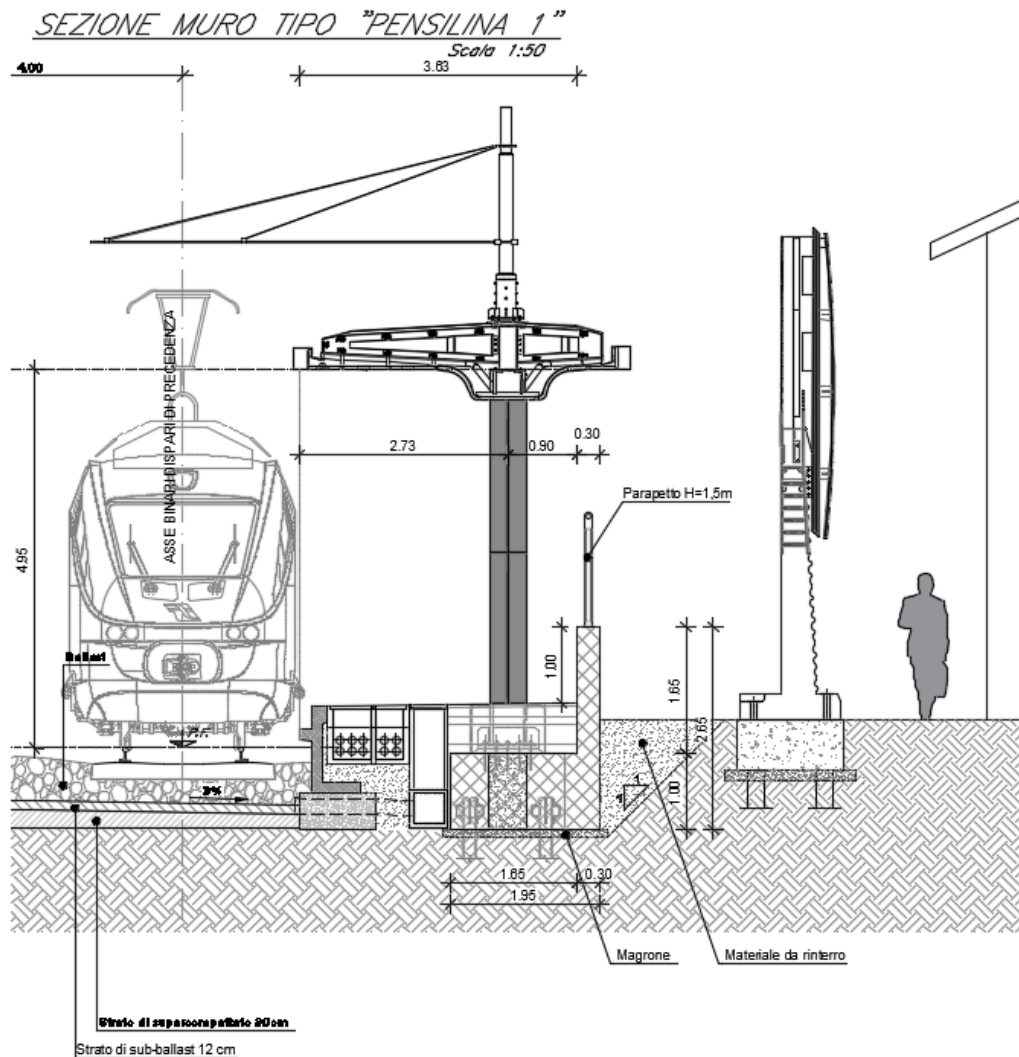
Sezione trasversale pensilina su "pensilina tipo 1"
